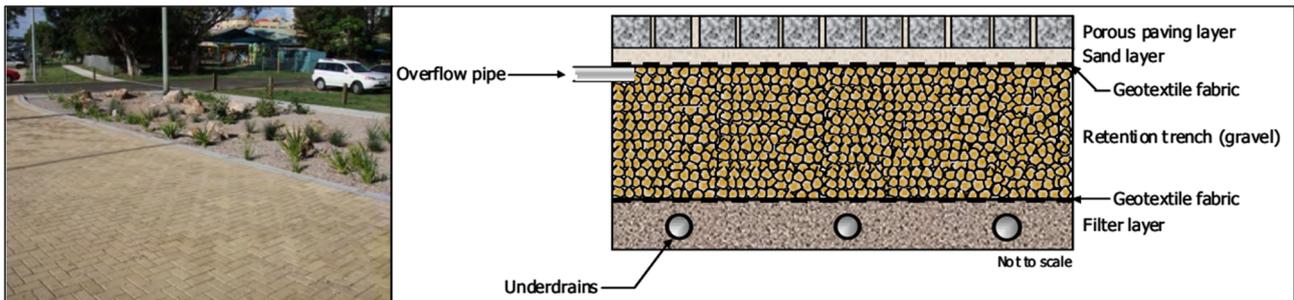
Exemplo australiano de pavimento poroso e perfil das camadas componentes do sistema. Fonte: JSCWSC, 2009.
